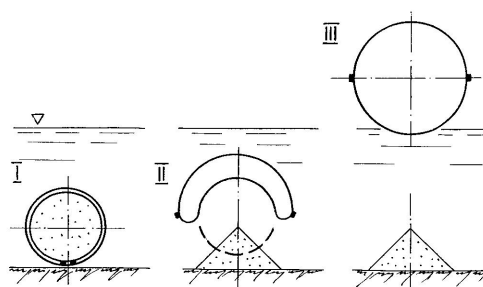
Схема демонтажа грунтонаполняемой оболочки
